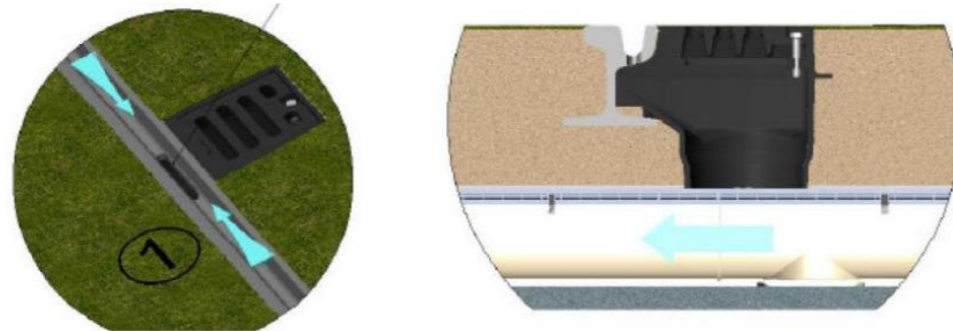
exemple d'évacuation d'eau de la gorge des rails dans une boîte de drainage
